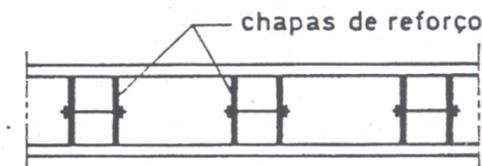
, 185 – Reforço de resistência de pavimento com novas vigas de madeira e chapas metálicas
